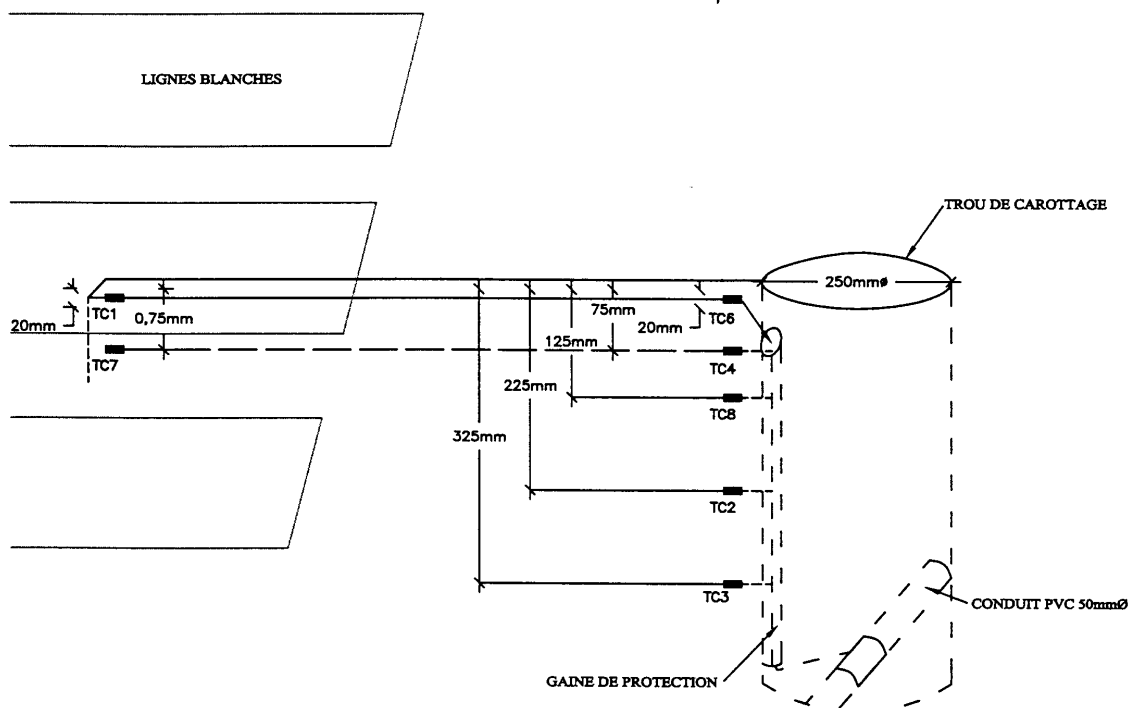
B VUE EN COUPE-THERMOCOUPLES
